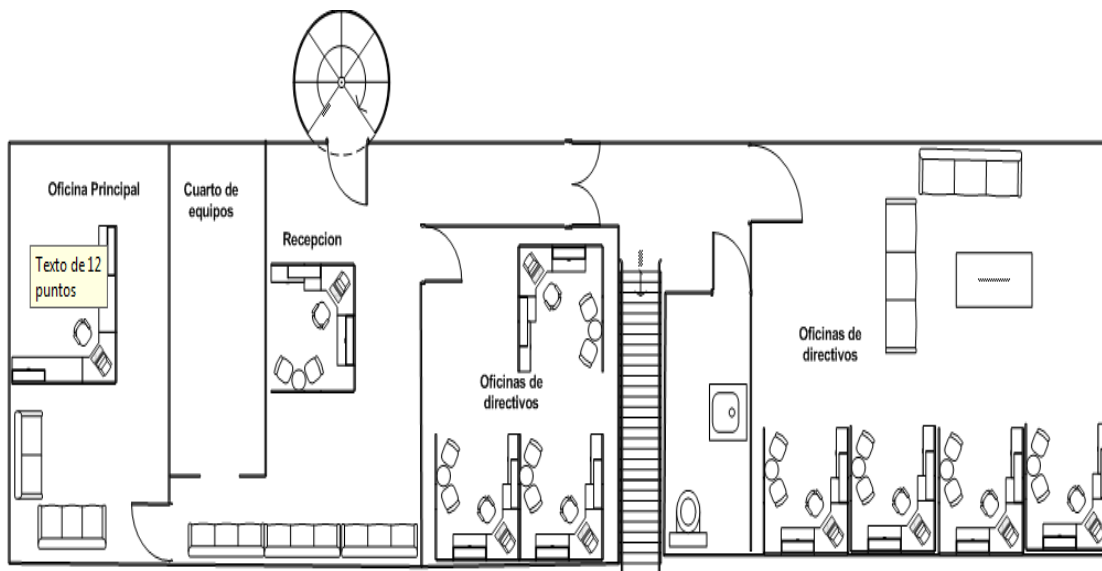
Plano de la segunda planta del Club House del EJPB
